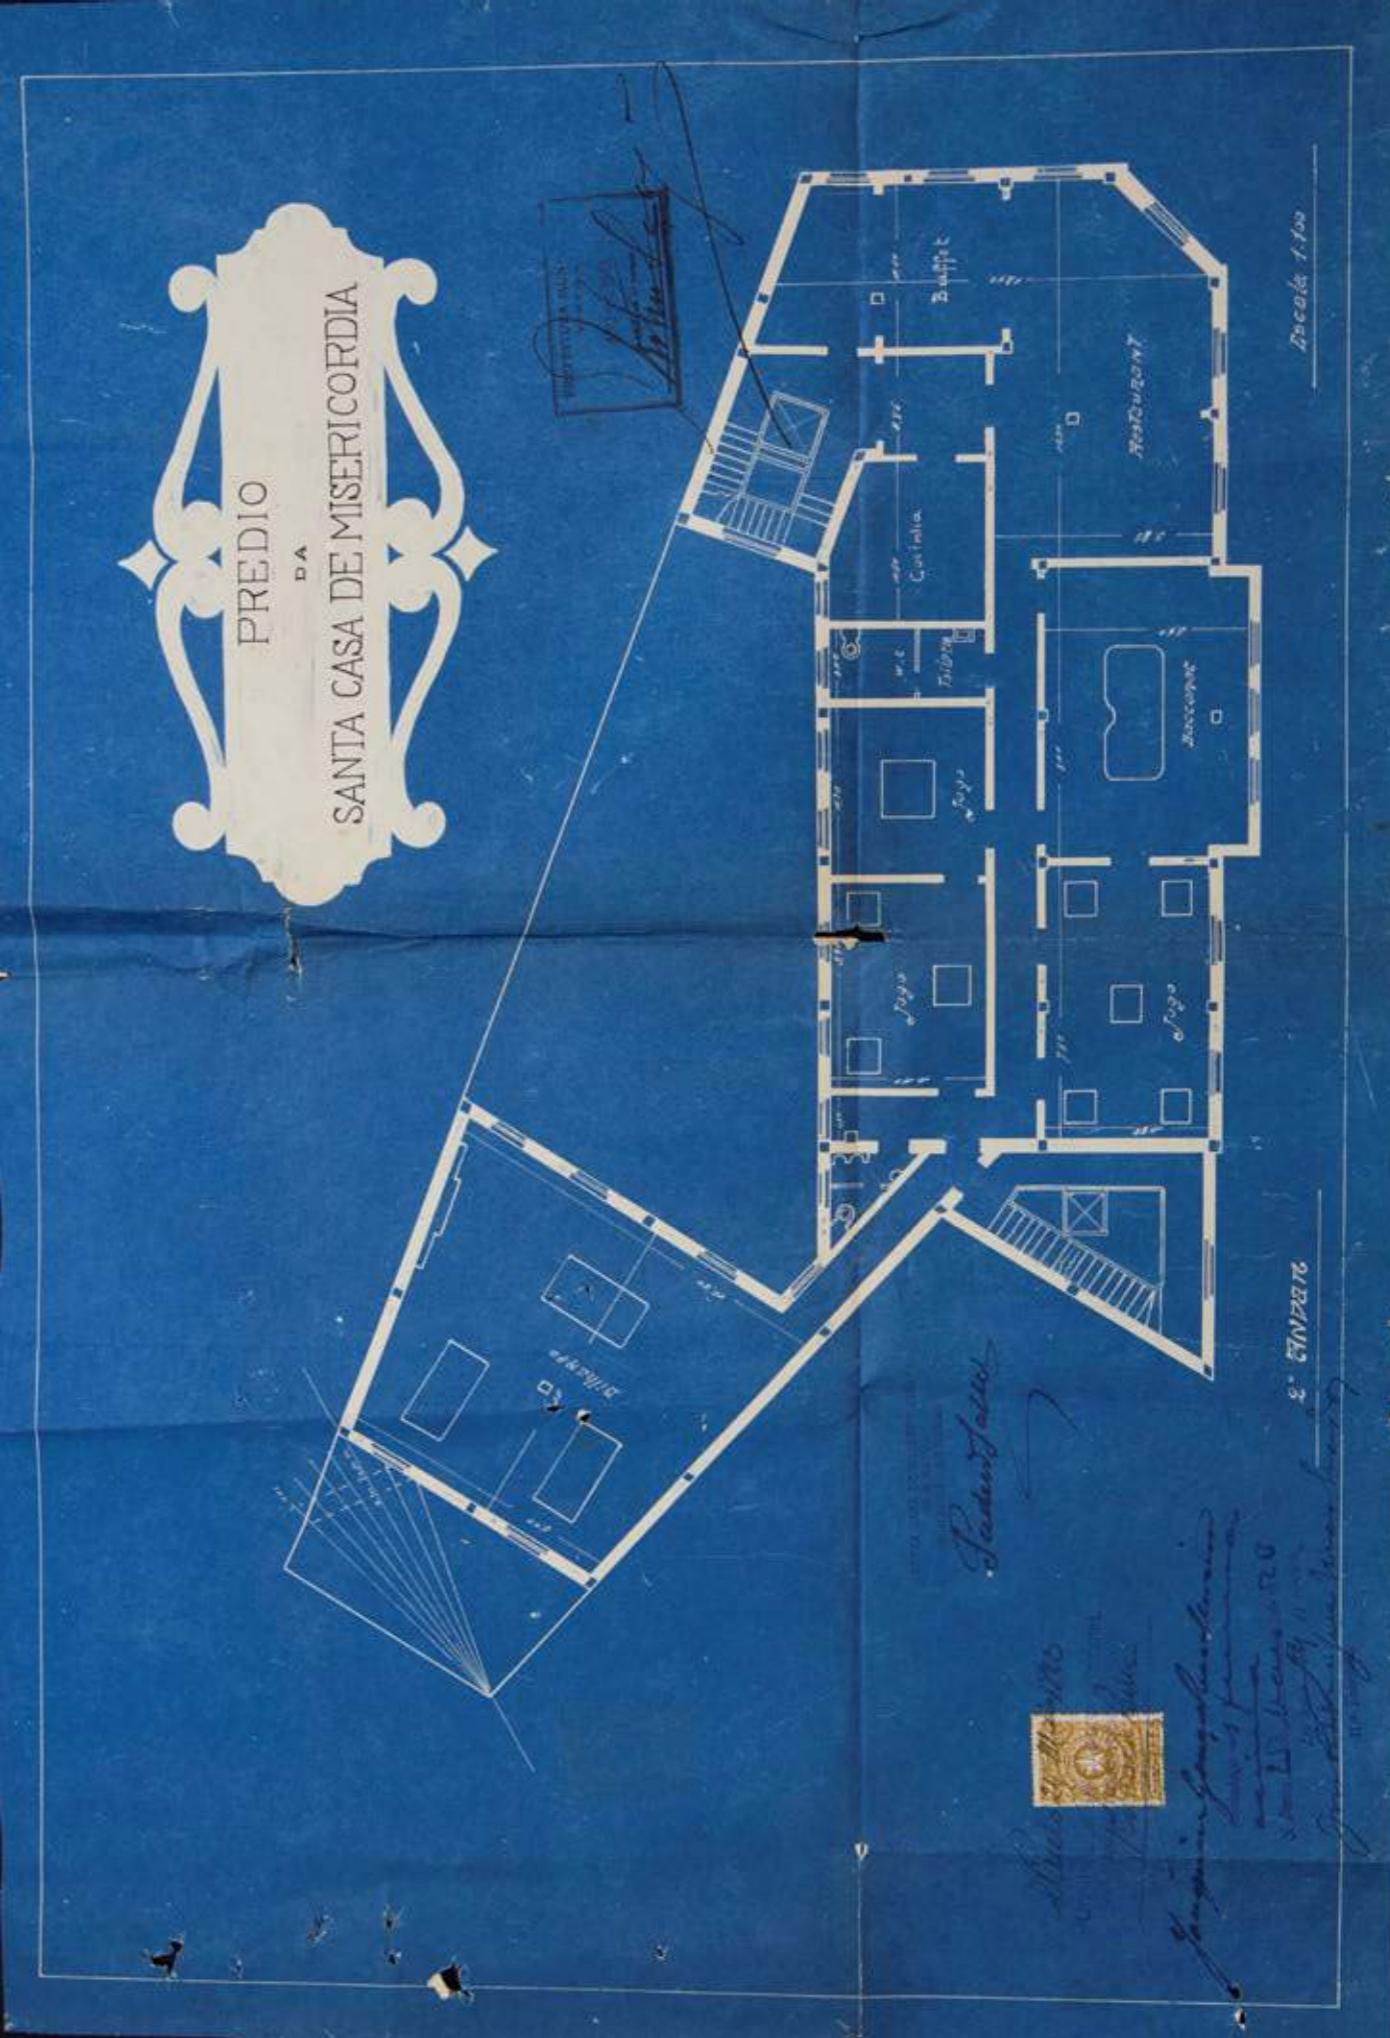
Planta do 3º pavimento (2º andar), 1923. Fonte: Arquivo Histórico de São Paulo.
